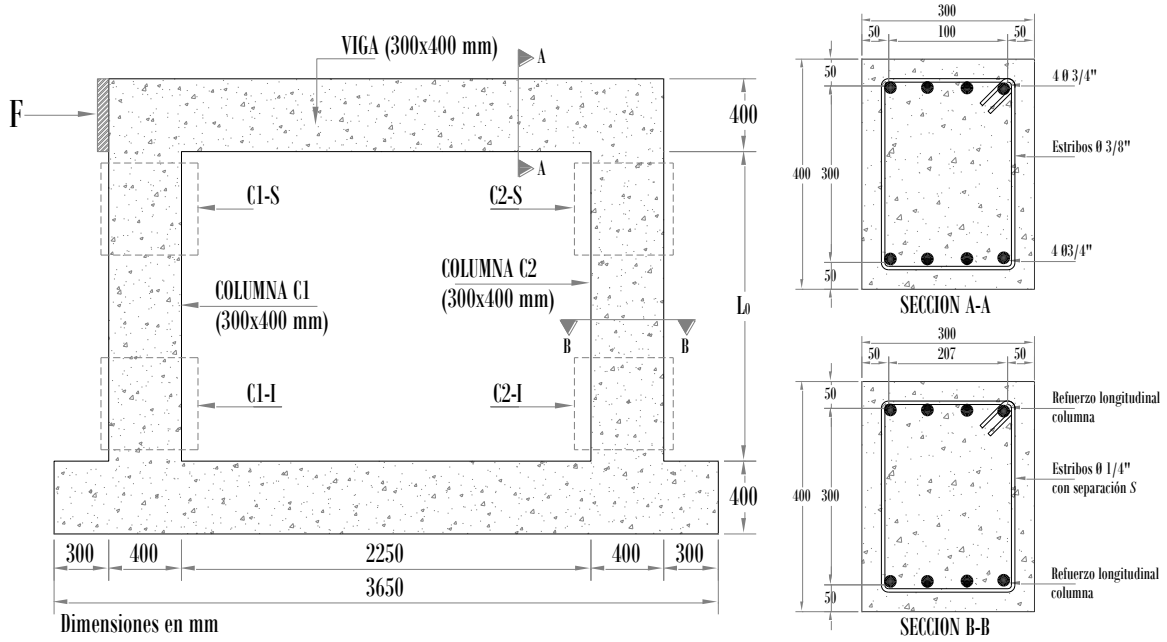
Pórtico de hormigón reforzado con insuficiencia a cortante en columnas
